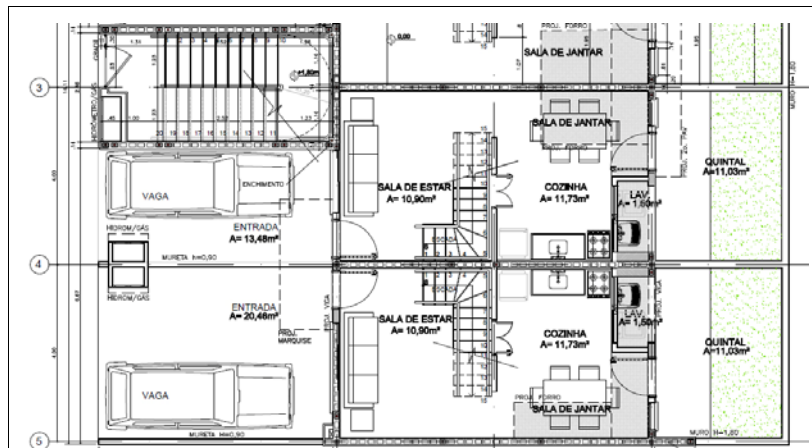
Planta pavimento térreo Edifício SB22. Fonte: CDHU (2012)
